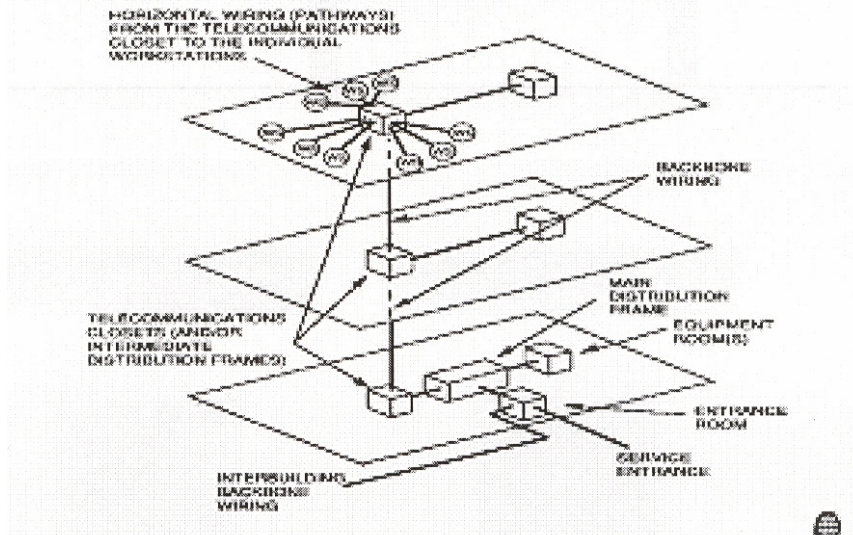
Topología Típica del Sistema de Cableado Estructurado.
